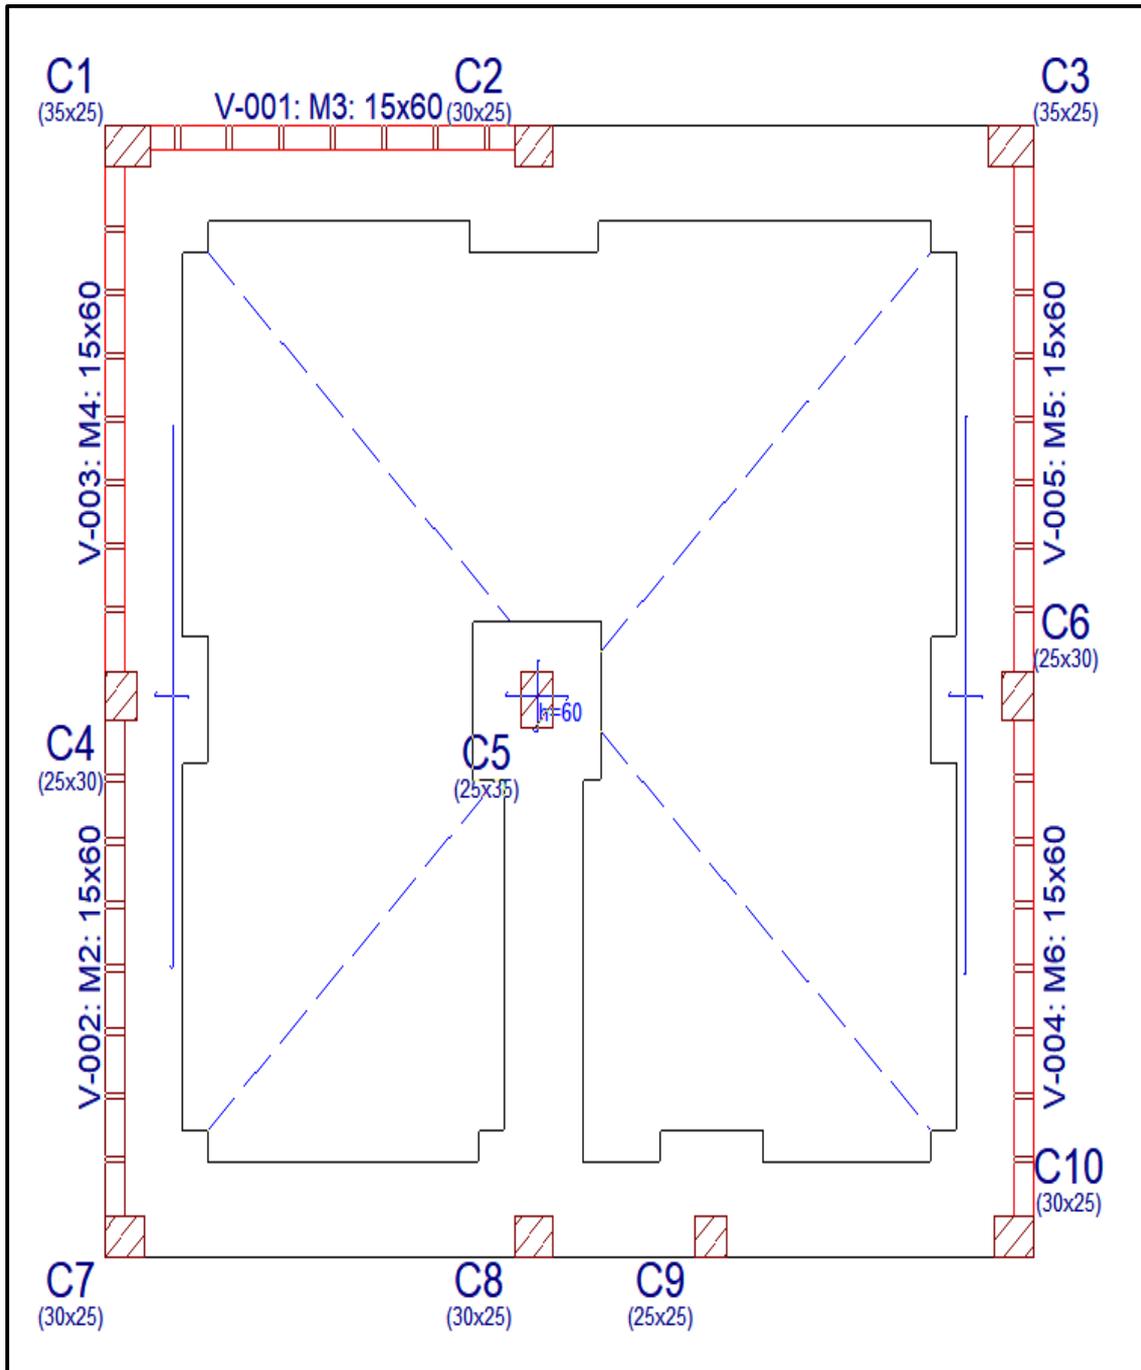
Plano de vivienda n4 indicando tracción excesiva en el muro m3
